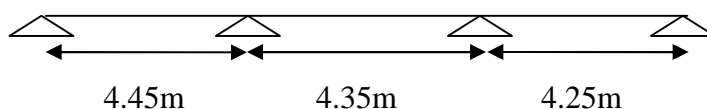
Schéma statique du 4ème type de poutrelles.
